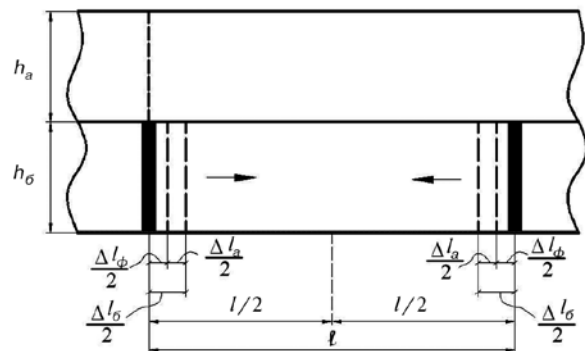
Схема перемещения под слоем асфальтобетона плит цементобетонного основания в поперечном шве или трещине при понижении температуры покрытия
